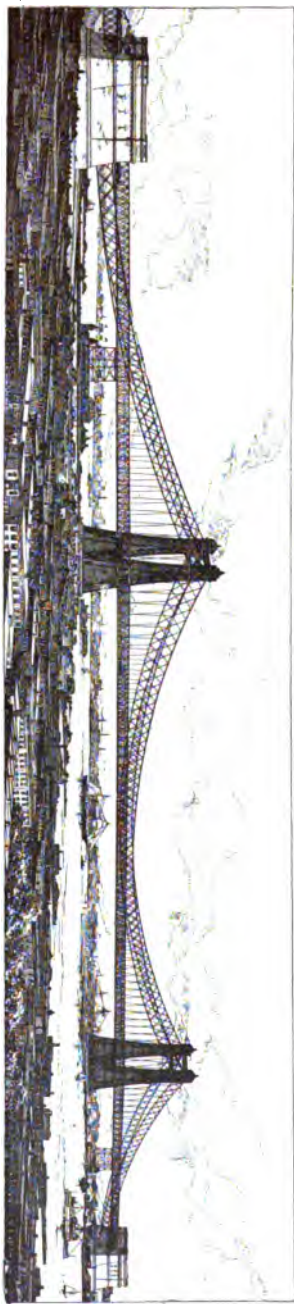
Pont sur l'Hudson à New-York, d'après le premier Projet.
